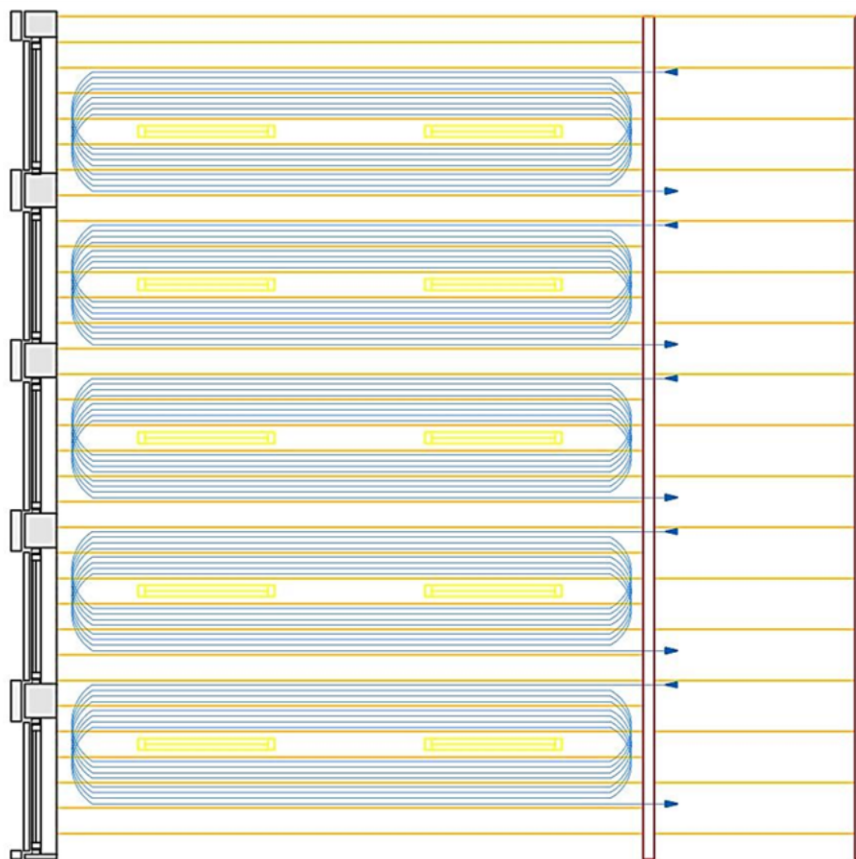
exemple de plan de principe plafond SAPP Ceiling®, modulation 1350 mm
